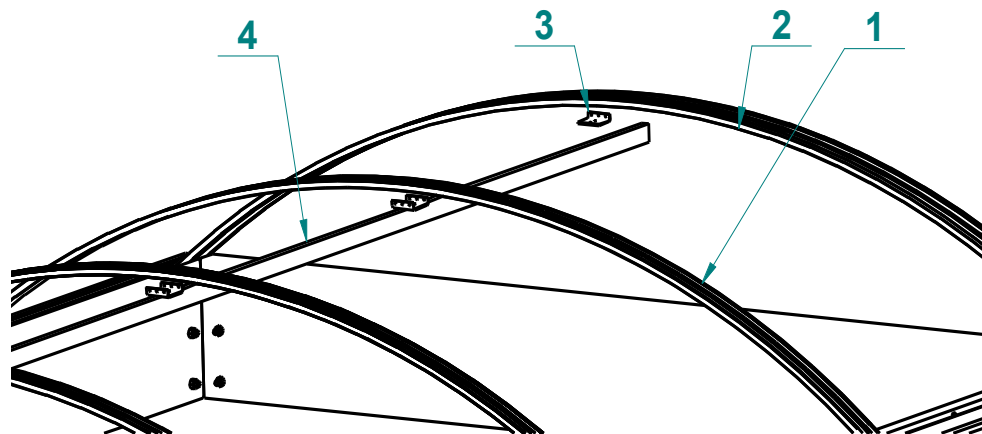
Montaż pająka(konstrukcji wsporczej pod klapę).
